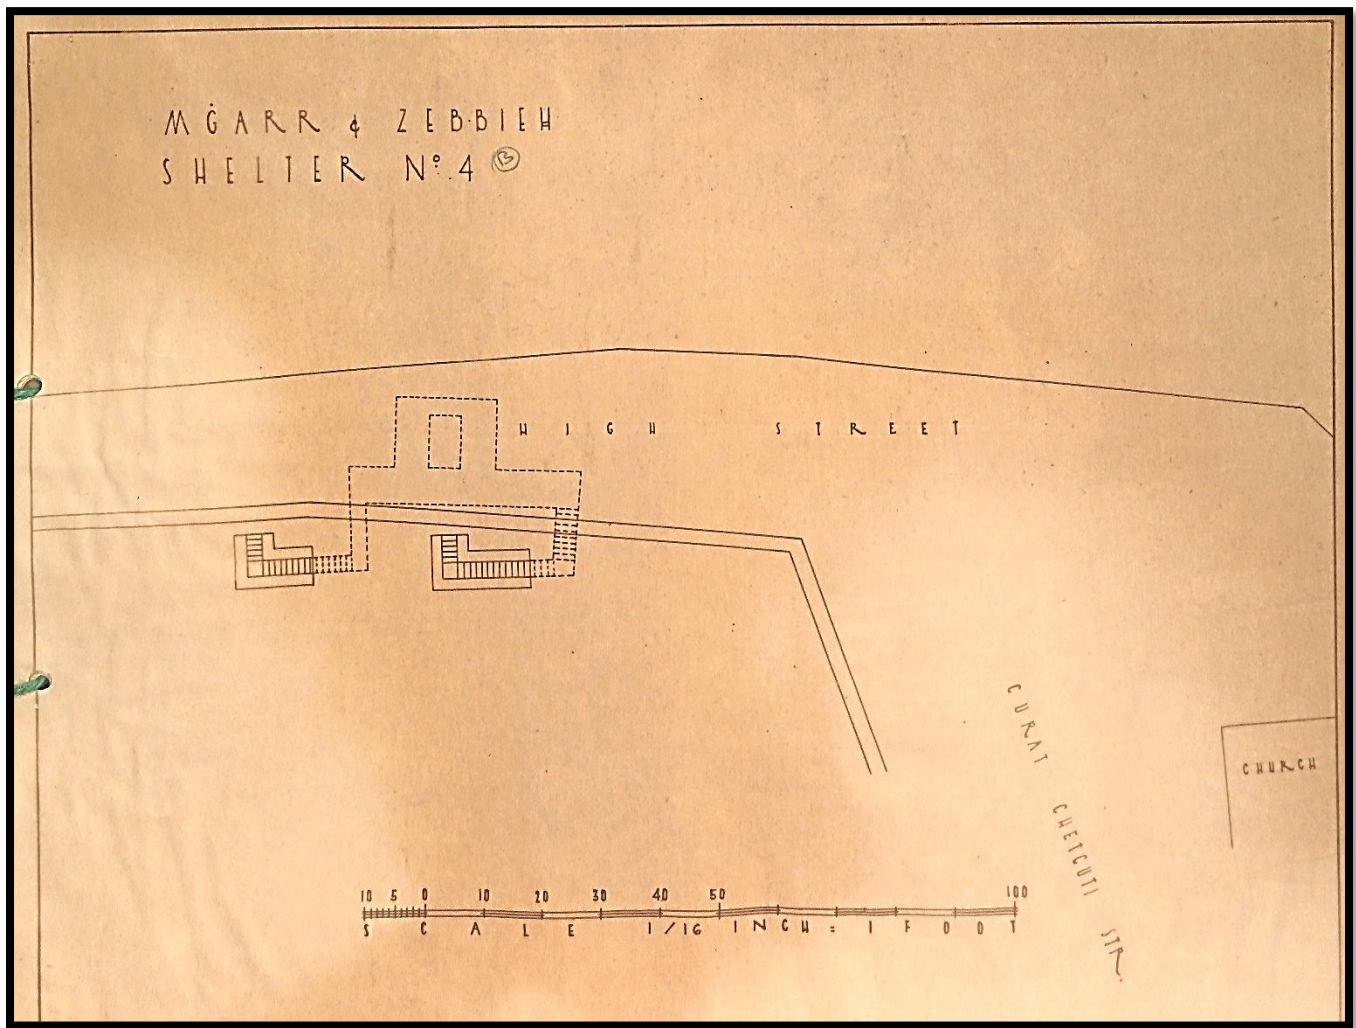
Planta do Abrigo nº4B "High Street – Curat Chetcuti Str."
